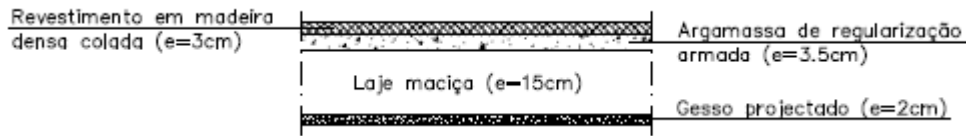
Pormenor construtivo do pavimento 3 [17]
